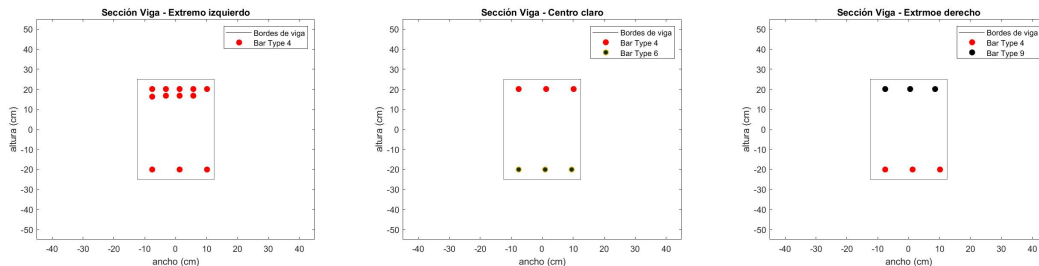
Secciones del modelo estructural 02: (Izq) Sección transversal en el extremo izquierdo de la viga con el refuerzo óptimo, (Cen) sección transversal al centro del claro de la viga con el refuerzo óptimo, (Der) sección transversal al extremo derecho de la viga con refuerzo óptimo..
